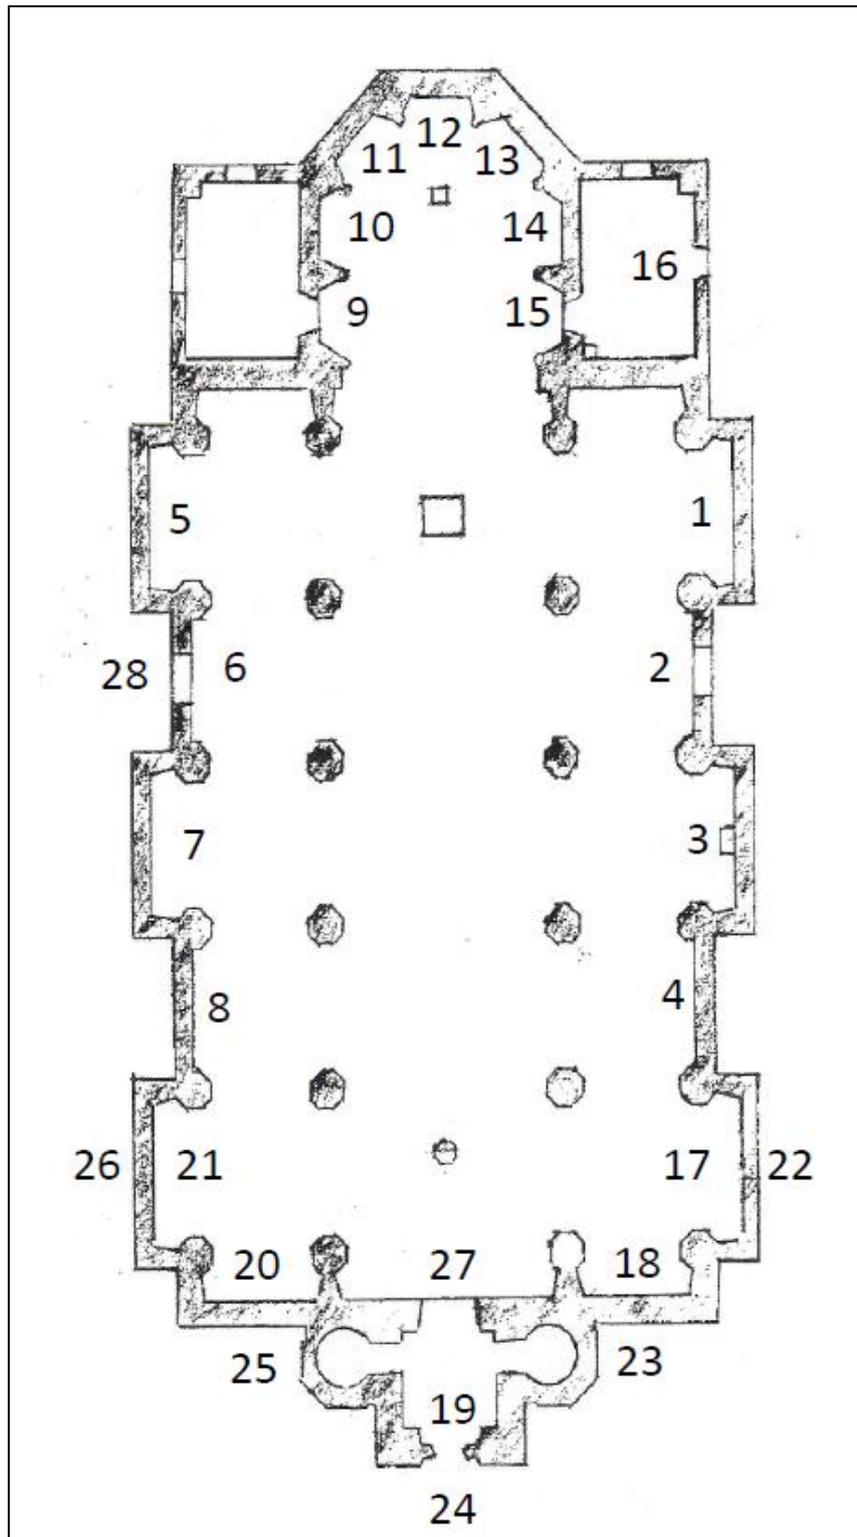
Grundriss der Pfarrkirche St. Peter mit Nummerierung der Fenster.
